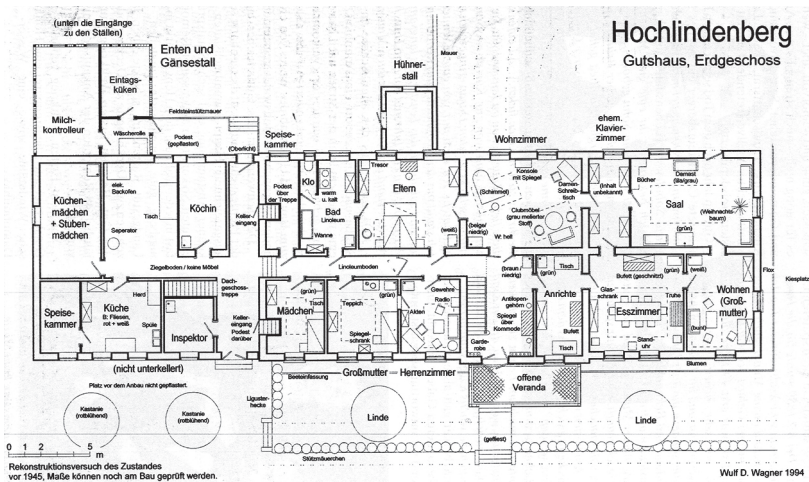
Хохлинденберг/Подлипово. План 1-го этажа
